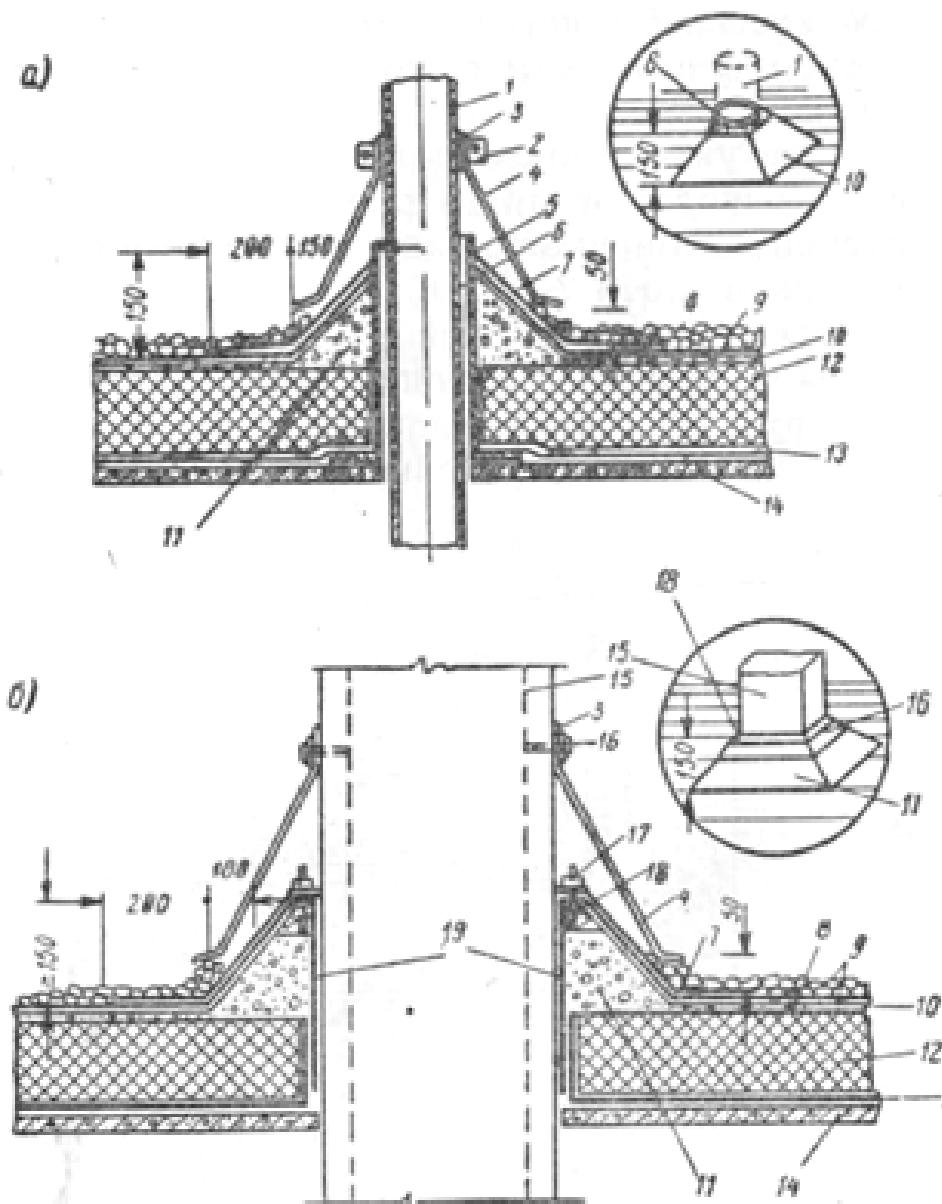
Примыкание рулонного гидроизоляционного ковра к различному оборудованию а – к трубам и мачтам; б – к вентиляционной шахте; 1 – труба или мачта; 2 – обжимное кольцо; 3 – промазка суриком; 4 – зонт из оцинкованной кровельной стали; 5 – просмоленная пакля; 6 – патрубок; 7 – дополнительный слой мешковины; 8 – гидроизоляционный ковер (основной) из четырёх слоев толь-коши; 9 – двухслойное защитное гравийное покрытие гидроизоляционного ковра; 10 – основание (стяжка); 11 – борт из раствора или бетона; 12 – теплоизоляция; 13 – пароизоляция; 14 – несущая плита покрытия; 15 – вентиляционная шахта; 16 – крепление зонта оцинкованными дюбелями; 17 – оцинкованные гвозди с шайбами; 18 – антисептированный деревянный бруск; 19 – слой толь-коши
